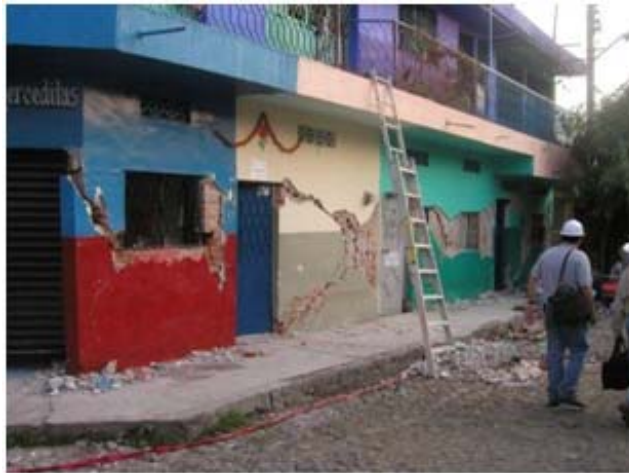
Fallas típicas por corte en la mampostería no reforzada (Terremoto de Tecomán, Colima, 2003)
